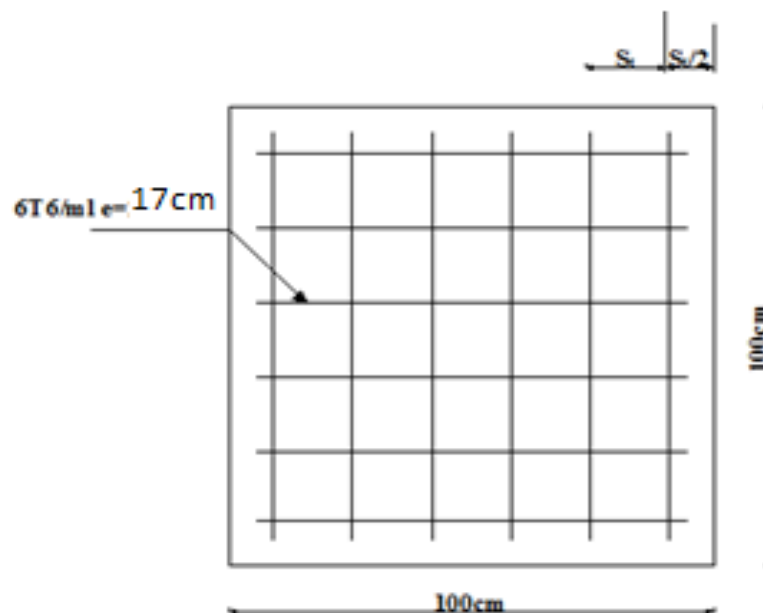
Disposition constructive des armatures de la table de compression.
